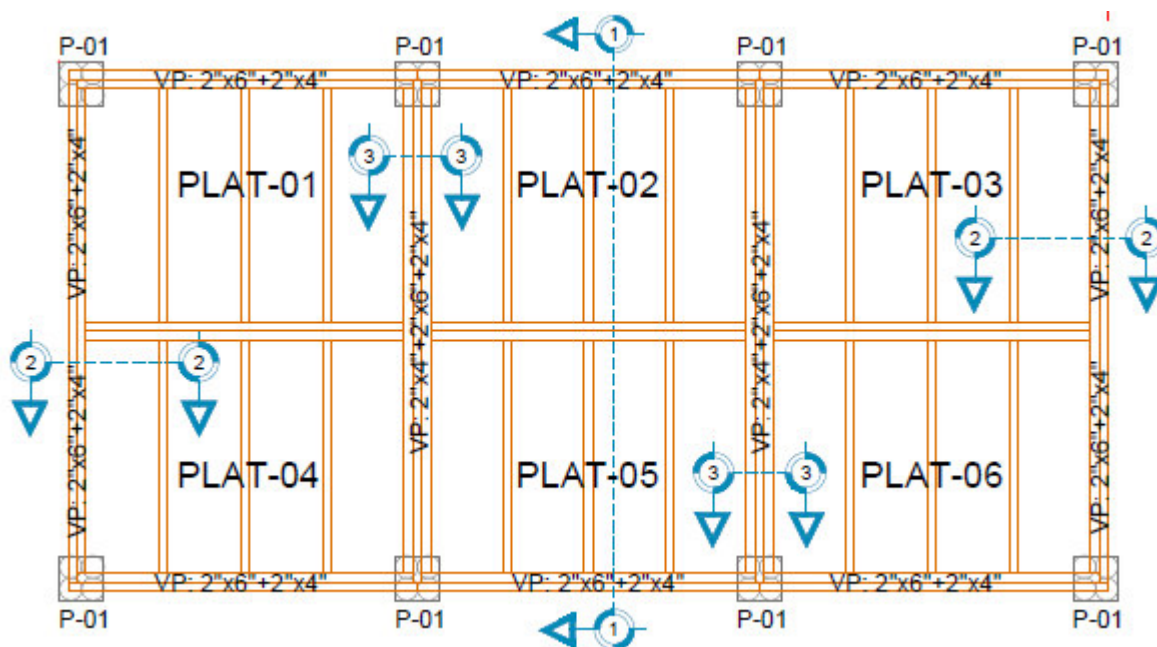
Detalle de Plataforma – Sistema de Entramados de Madera
